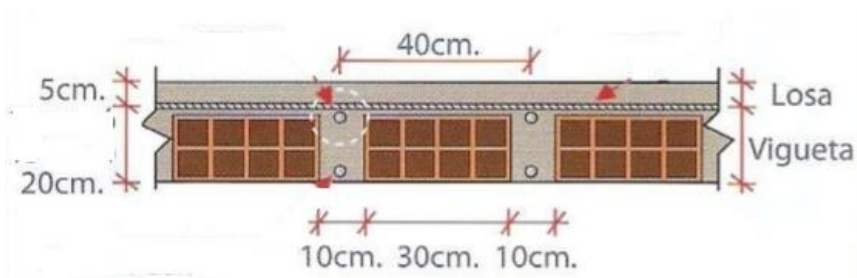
Detalle de la losa aligerada de 25 cm de lña estructura 2.
